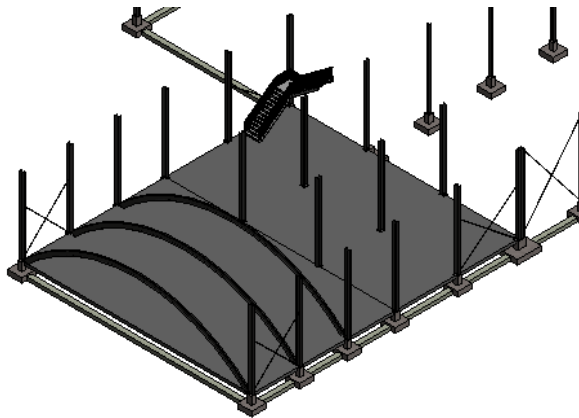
Resultado para el suelo en la primera planta en la zona de oficinas.
